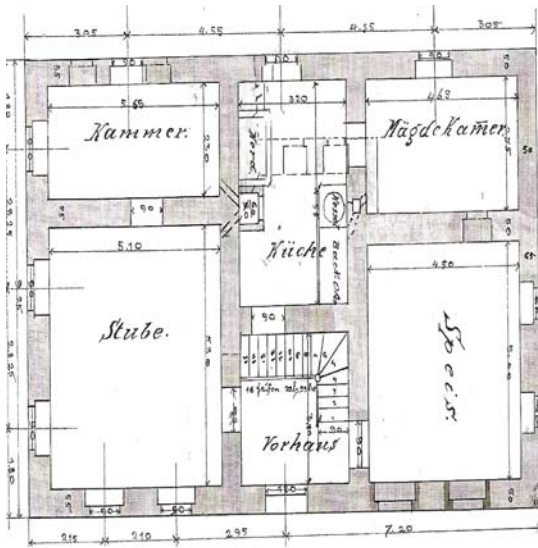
Bergerhöhe, Grundriss, 1887
